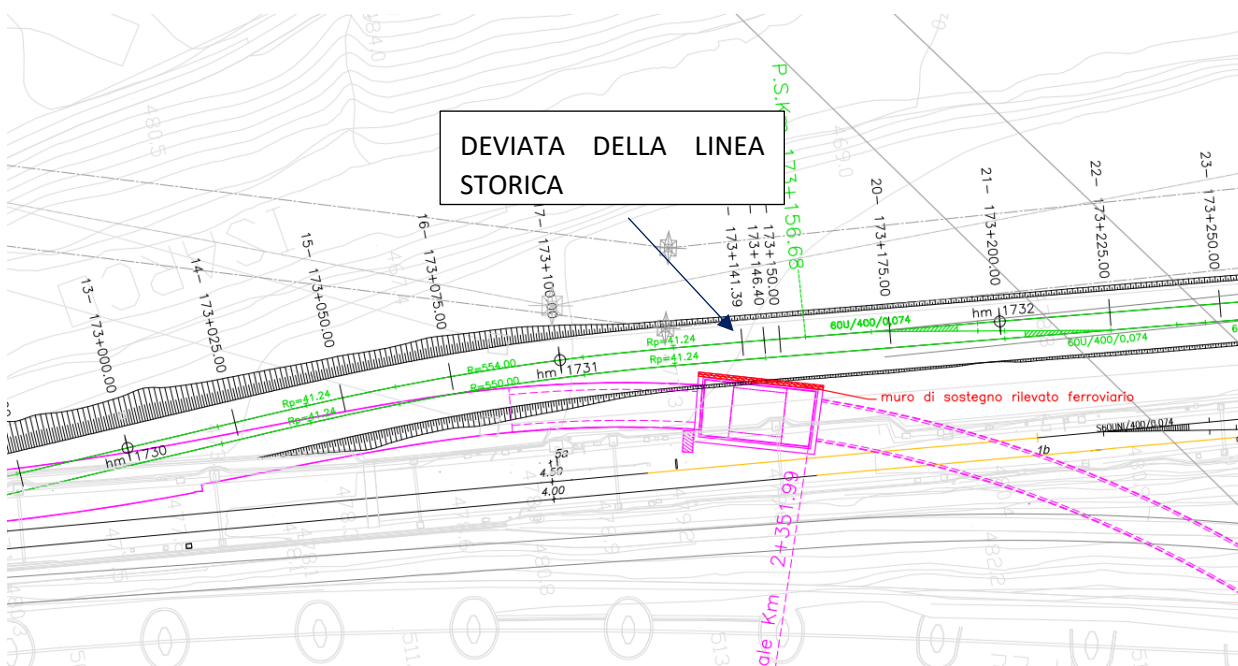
Sottoattraversamento linea storica: Progetto definitivo
